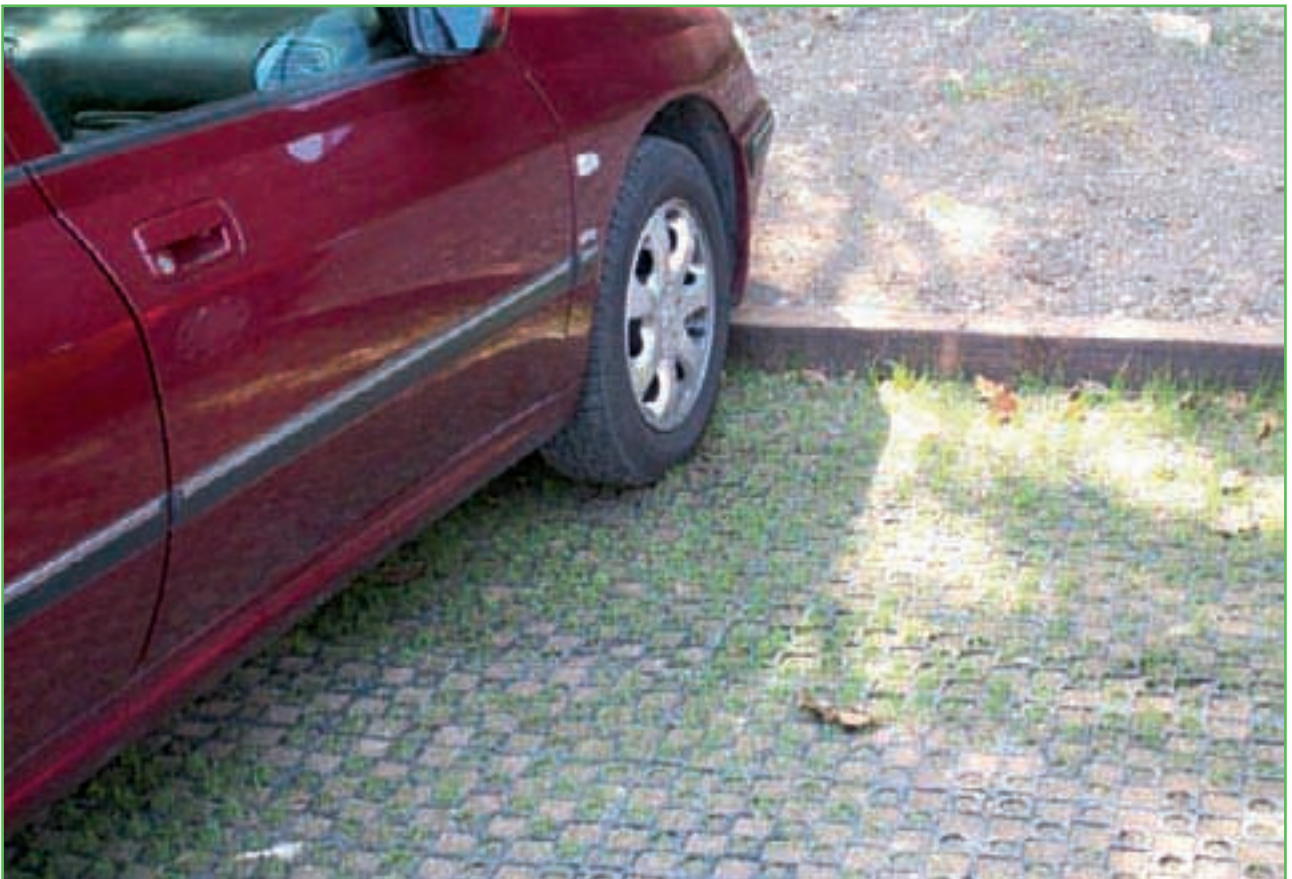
Detalle del pavimento drenante ecológico ATLANTIS.
